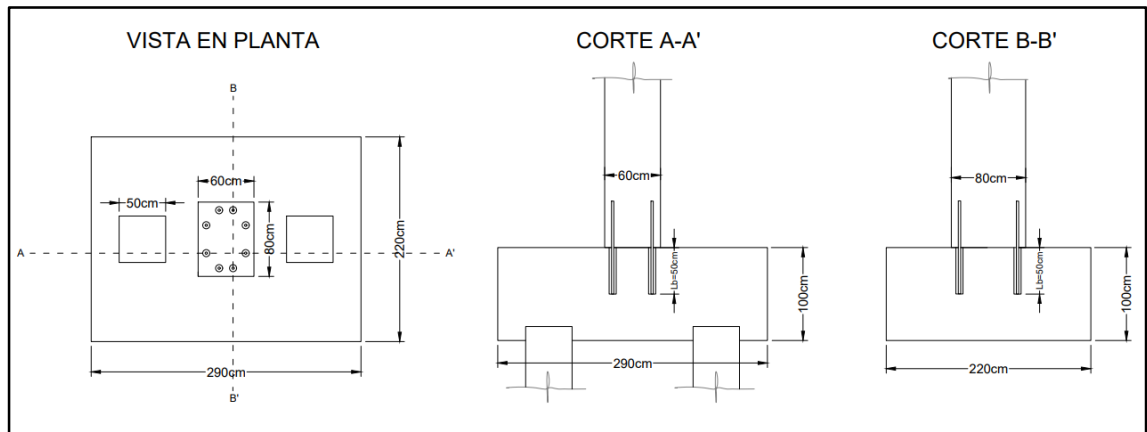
Vista en planta y frontal del dimensionamiento de la zapata. Fuente del autor.
